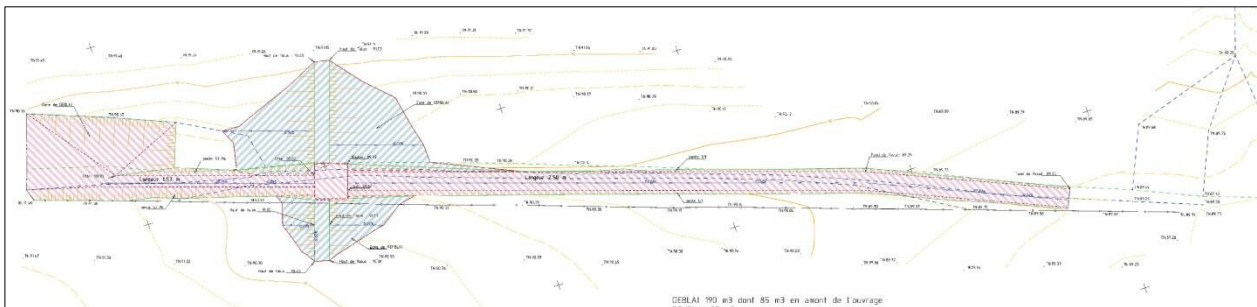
Plan d'exécution d'implantation de l'ouvrage
